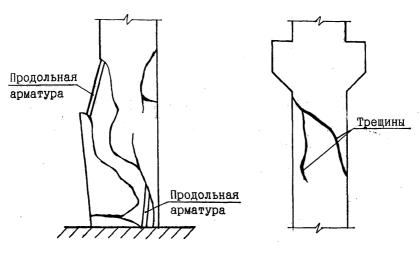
Повреждение железобетонных ригелей каркасных зданий от сейсмических воздействий
